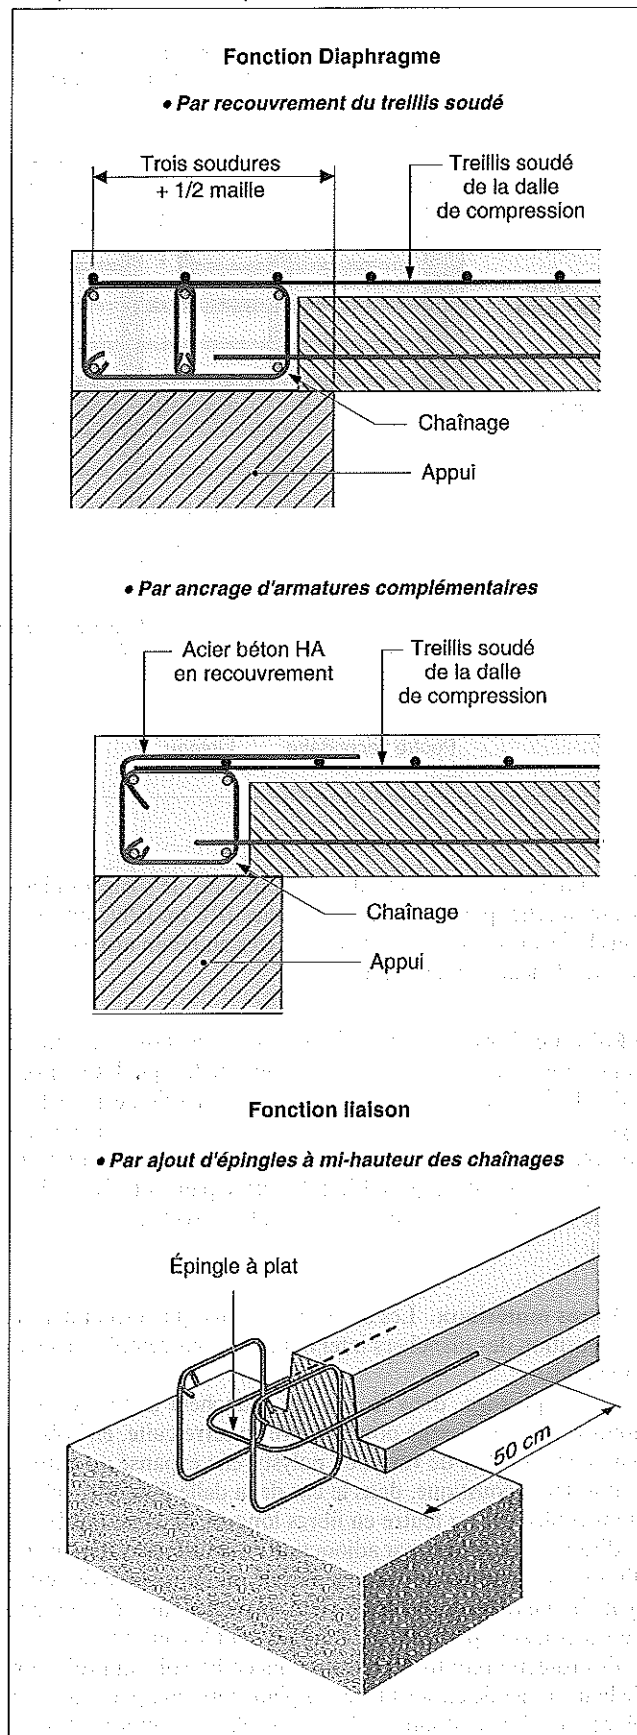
Dispositions parasismiques d'un plancher en poutrelle béton armé (source : NF P 06-014).
